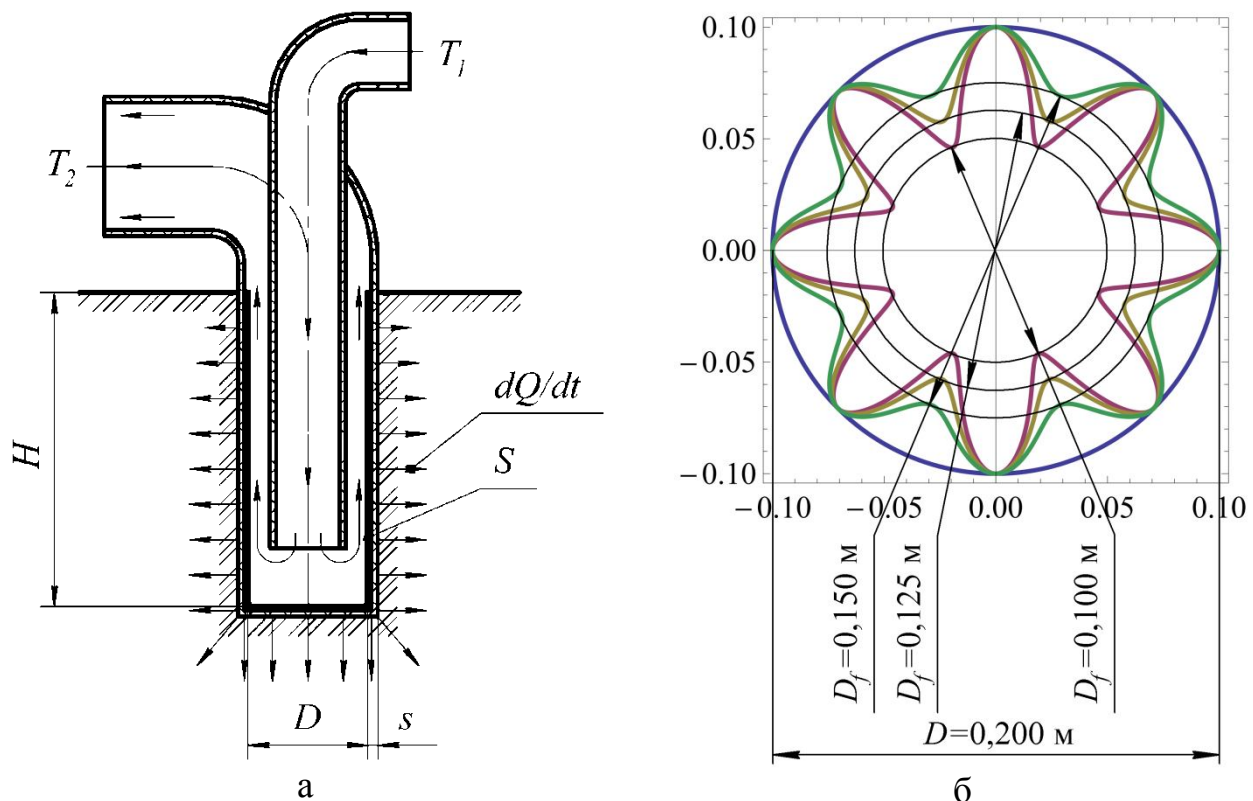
Продольное (а) и поперечное (б) сечение грунтового теплообменника
